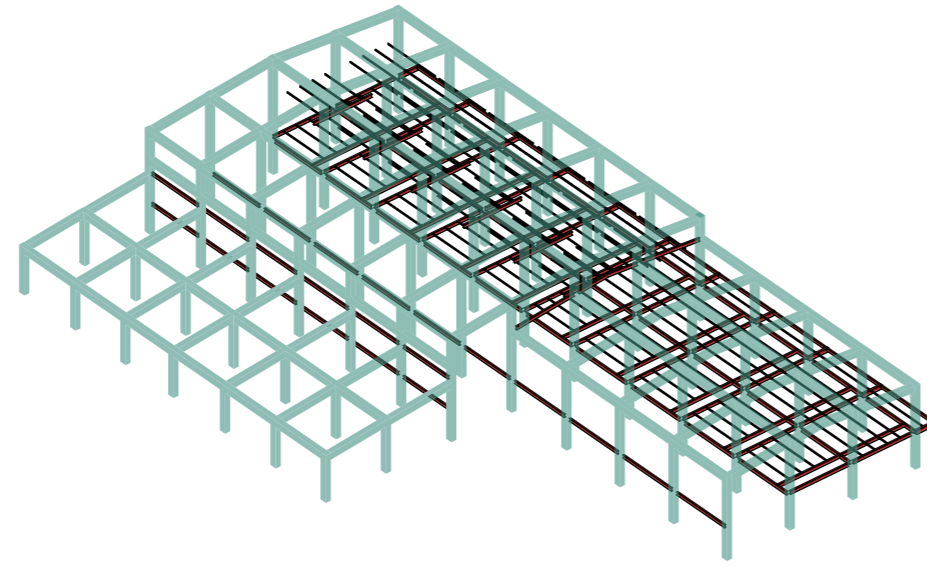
Estructura nueva de la planta de faenamiento. Fuente: Autoría propia.
